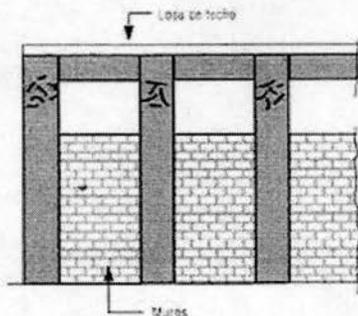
Fisuras o roturas en la cabeza de columnas cortas
